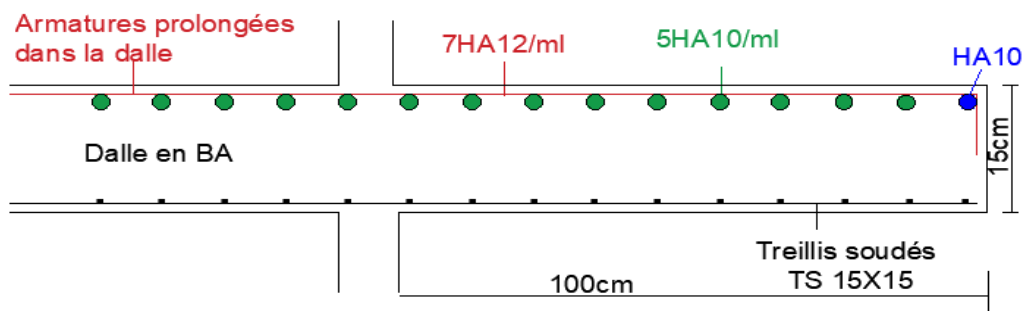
Coupe du schéma de ferrailage du balcon selon l'EC2.
